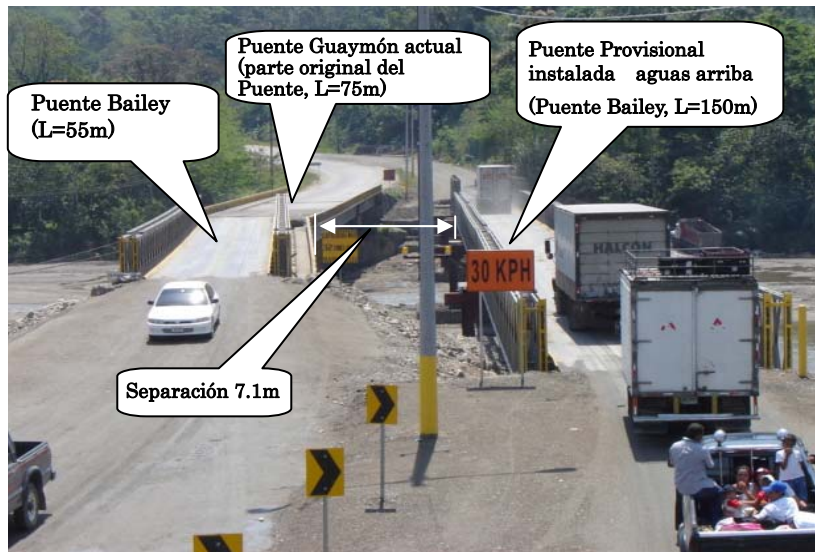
Situación Actual del Uso del Puente Guaymón
